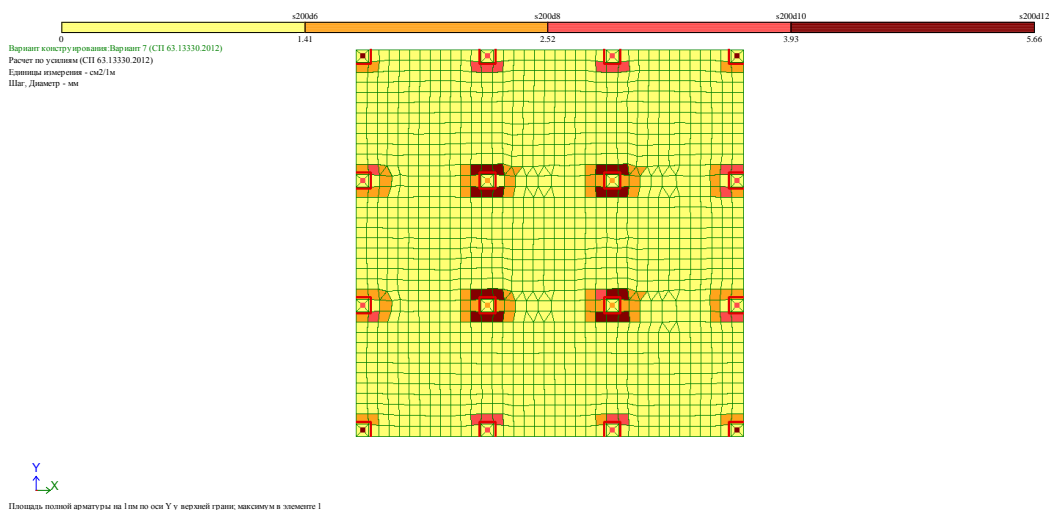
Подбор верхней поперечной арматуры плиты
